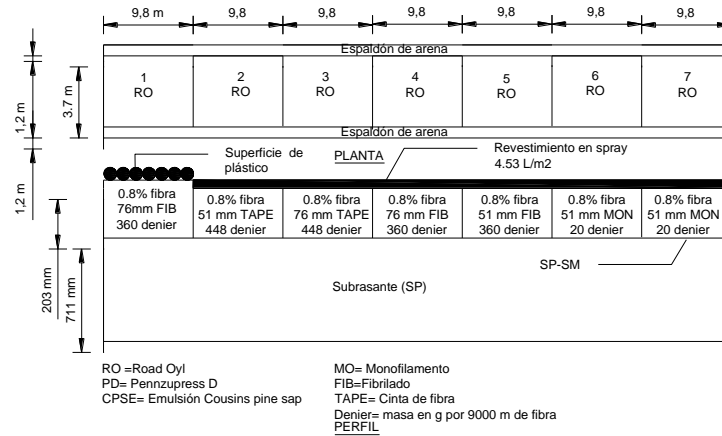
16 Planta y perfil de la sección de prueba 2 (Modificado de Tingle et al. 2002).
